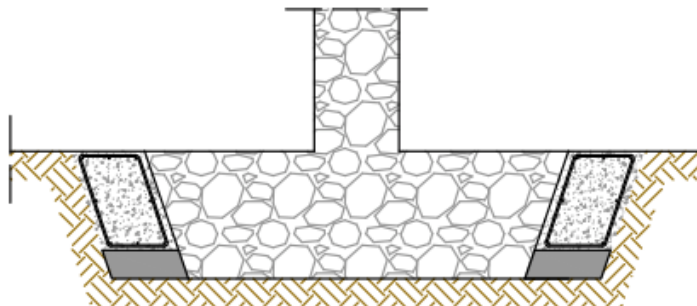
Sección zapata aislada. Refuerzo 2. Fuente propia.
